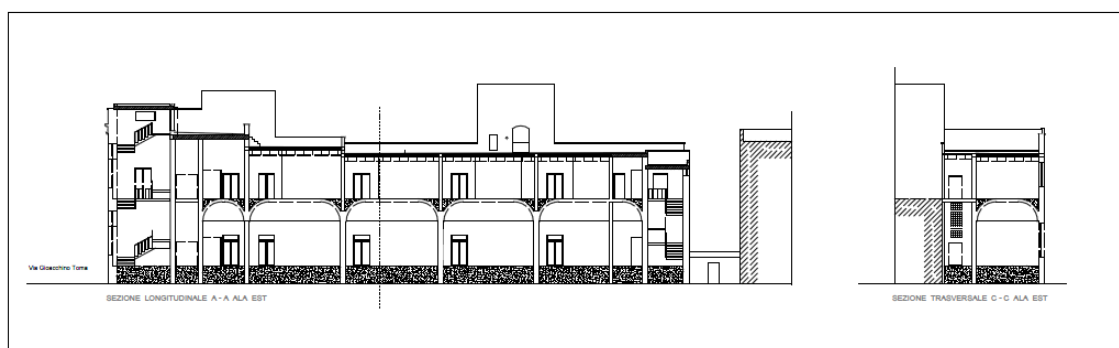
Sezione longitudinale e trasversale ala est dell'edificio.
